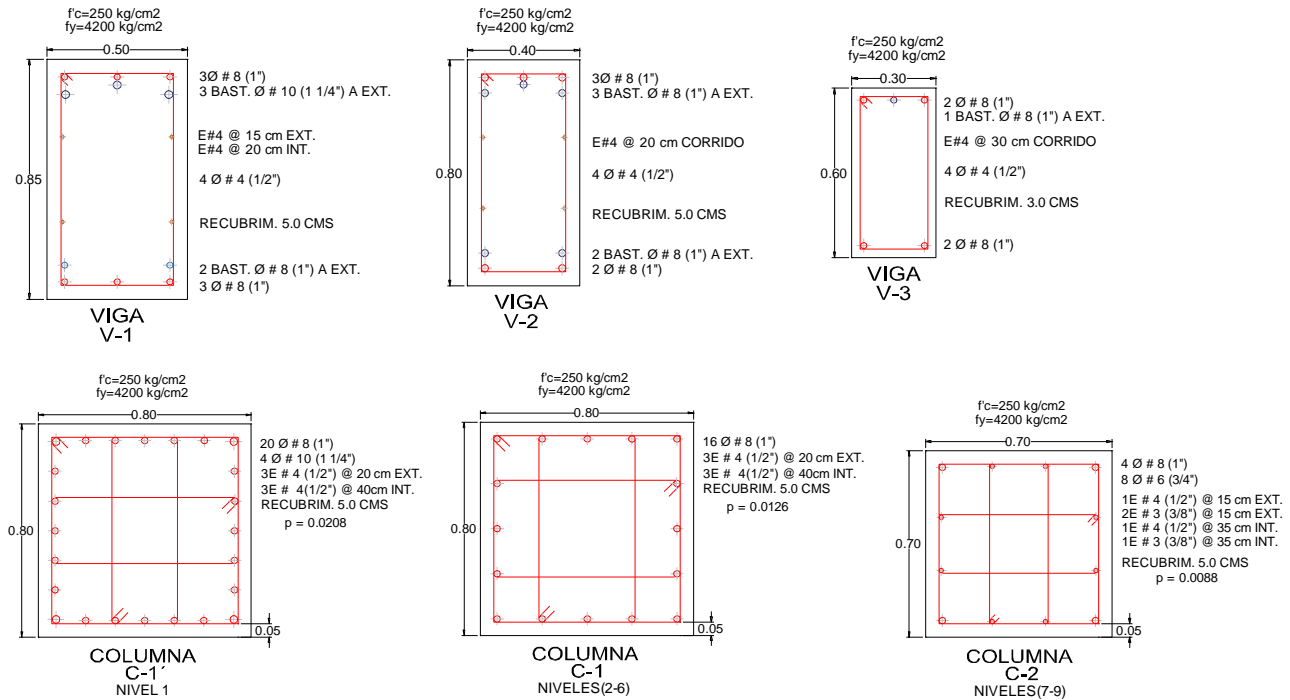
Detallado de armado de vigas y columnas del marco de 9 niveles con base a la hipótesis de las NTCC-04 (continuación).
